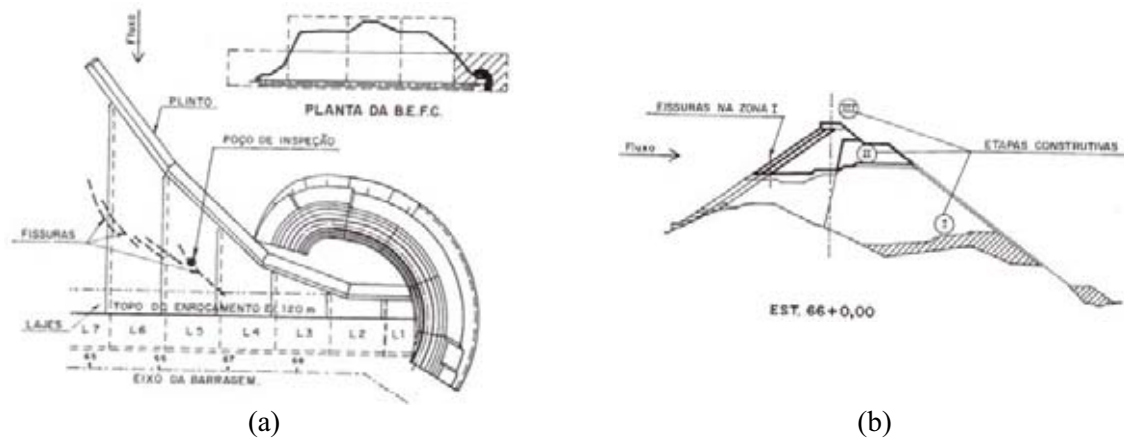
Barragem de Xingó: (a) Fissuras observadas na zona I; (b) Seção transversal (Souza et al., 1999).
